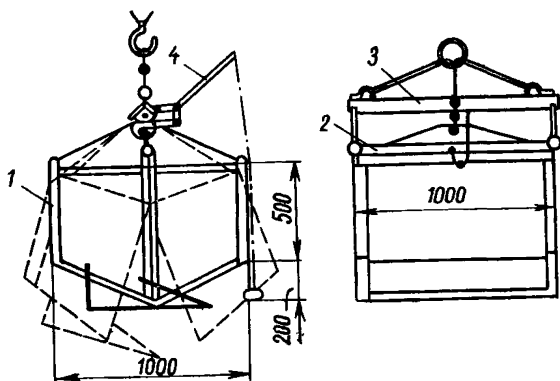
Контейнер (ковш) для уборки строительного мусора с перекрытий при разборке конструкций
